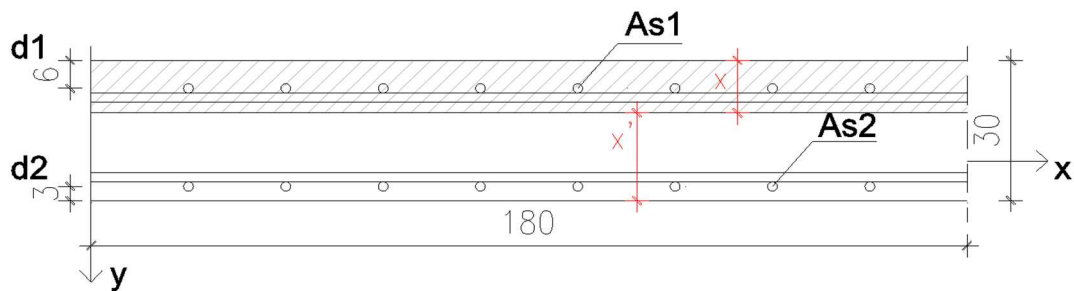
Sezione trasversale soletta in campata, quote in cm
